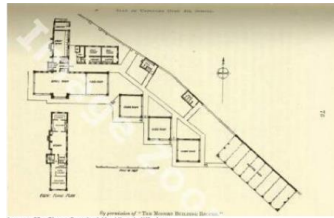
Planta. Escuela al Aire Libre de Ujjain.
